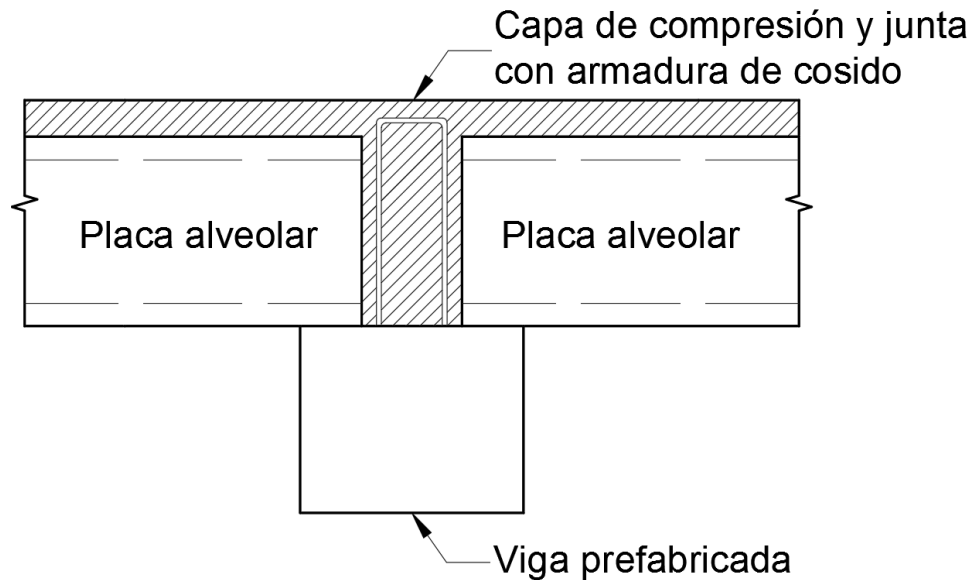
Unión en la junta viga-forjado, con armadura de cosido
